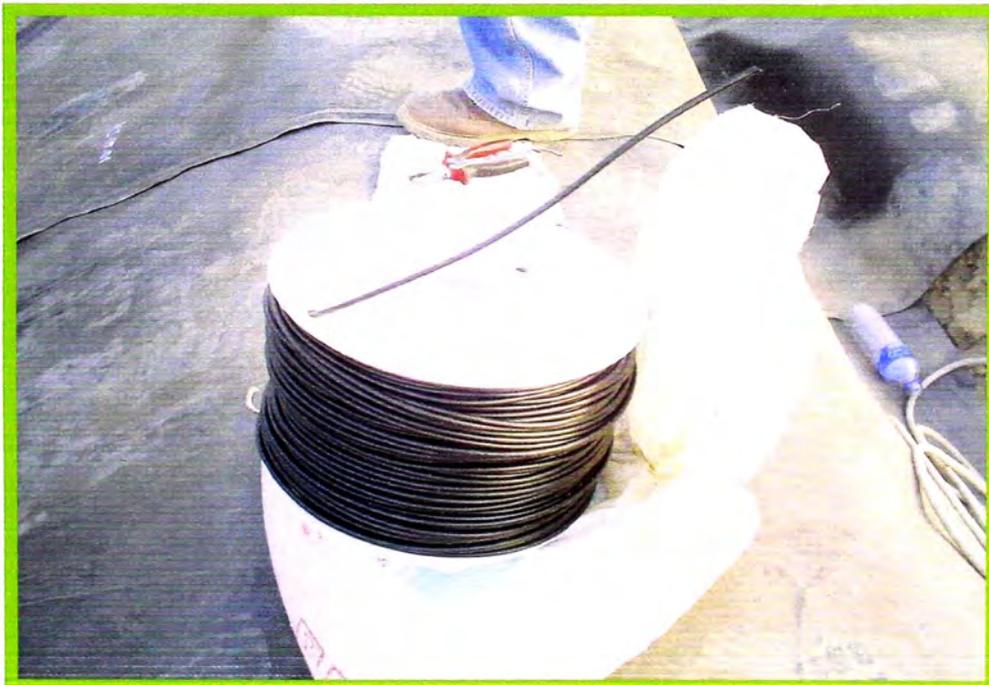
Soldadura para geomembrana por el Sistema de Extrusión
